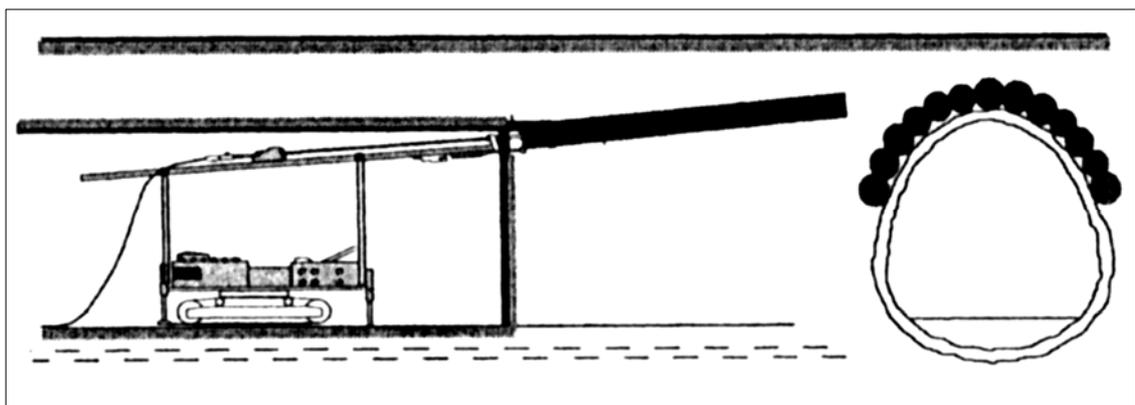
Horizontale Schirminjektion im Tunnelbau [26]
